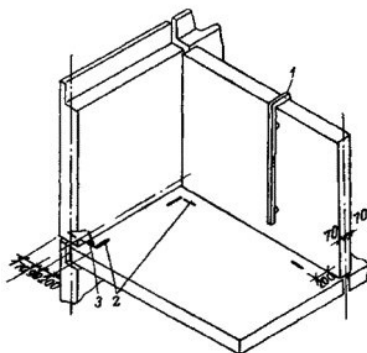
Схема нанесения на перекрытие ориентирных рисков до монтажа стеновых панелей:
